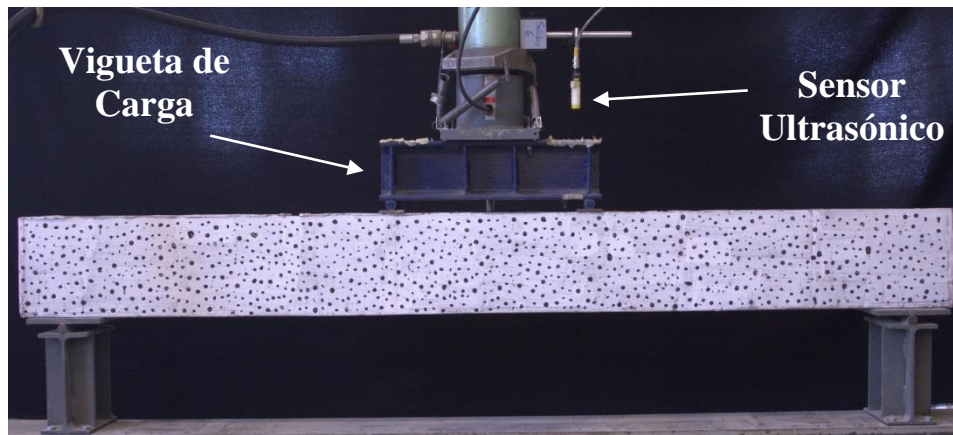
Montaje ensayo a flexión de vigas con armadura de acero.
